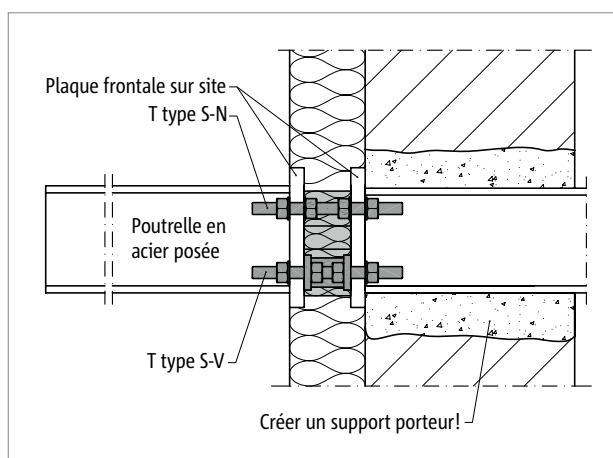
Schöck Isokorb® T type S-N et T type S-V : structure en acier supportée ultérieurement; pour d'autres exemples de rénovation, cf. page 103
